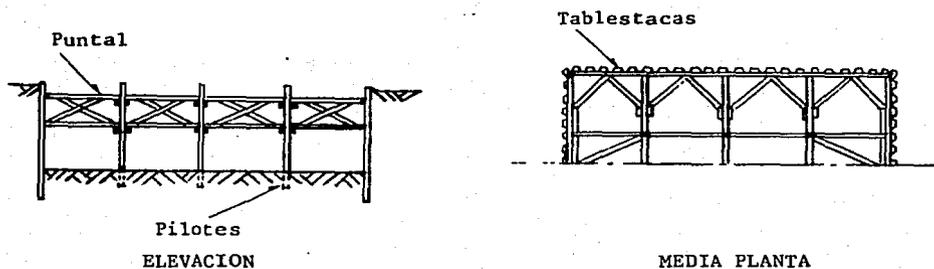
EXCAVACION ANCHA Y PROFUNDA.
